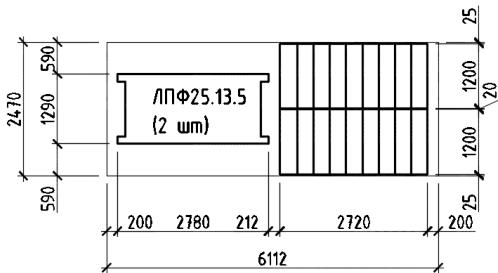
Схема раскладки лестничных маршей и лестничных площадок на транспортной платформе
